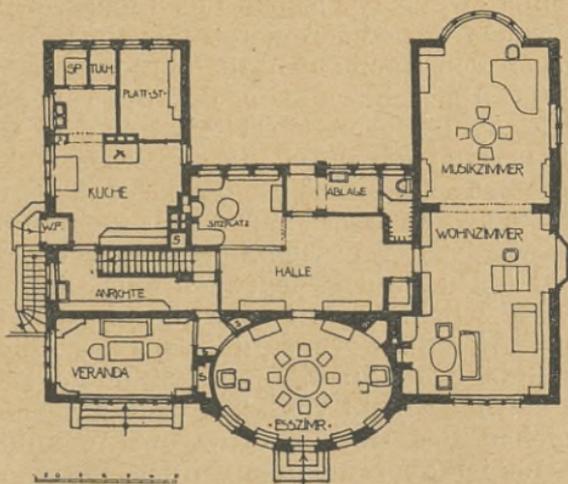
Haus mit einer Halle ohne Treppeneinbau
